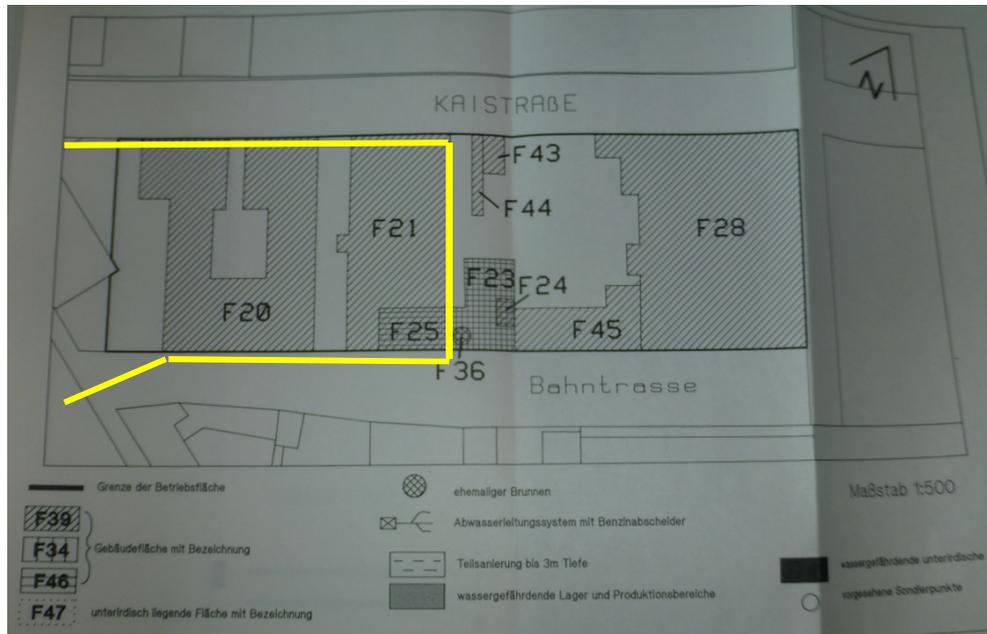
Lageplan der Altbebauungen aus /9/ mit Eintragung der ungefähren Lage des Projektgrundstückes (gelb)
